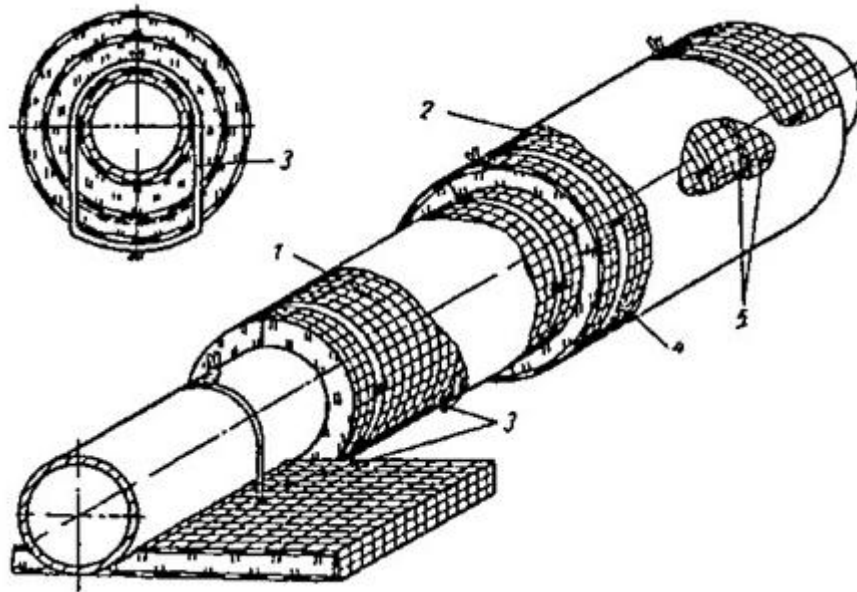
Тепловая изоляция трубопровода минераловатными плитами:
